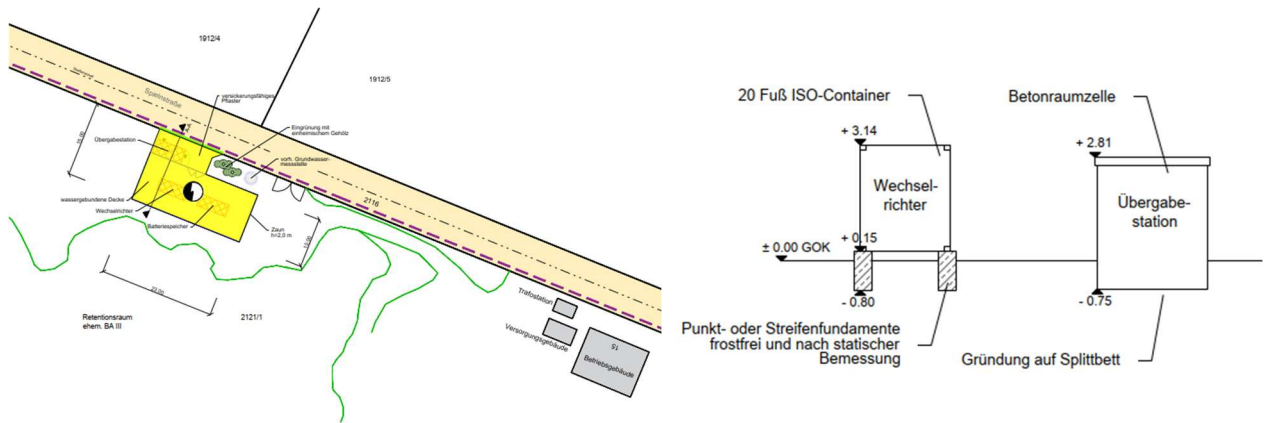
Vorplanung Batteriespeicher Spielstraße, 02.09.2025, Stadtwerke Rosenheim, Netzplanung Bau
